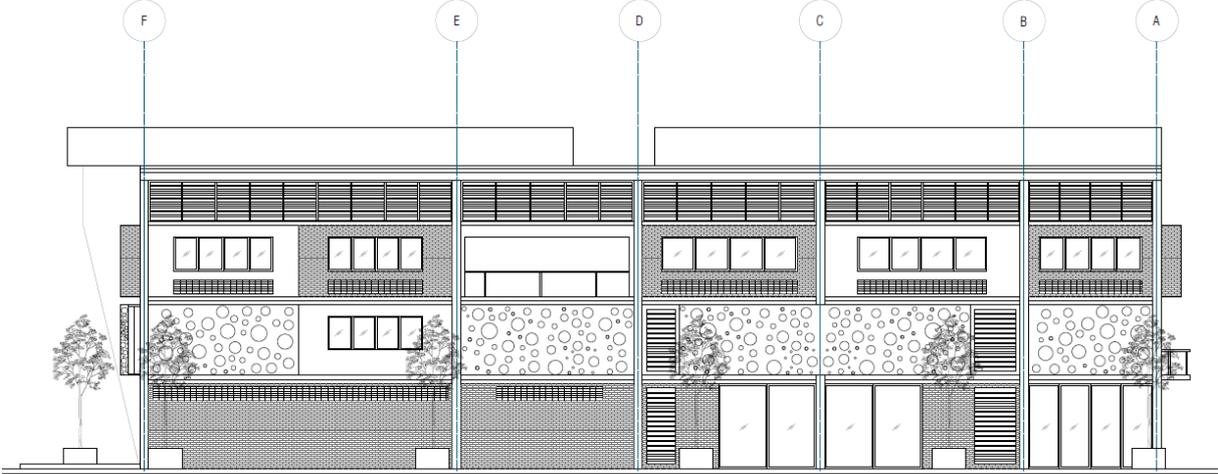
Fachada lateral izquierda. Fuente: Elaboración propia
